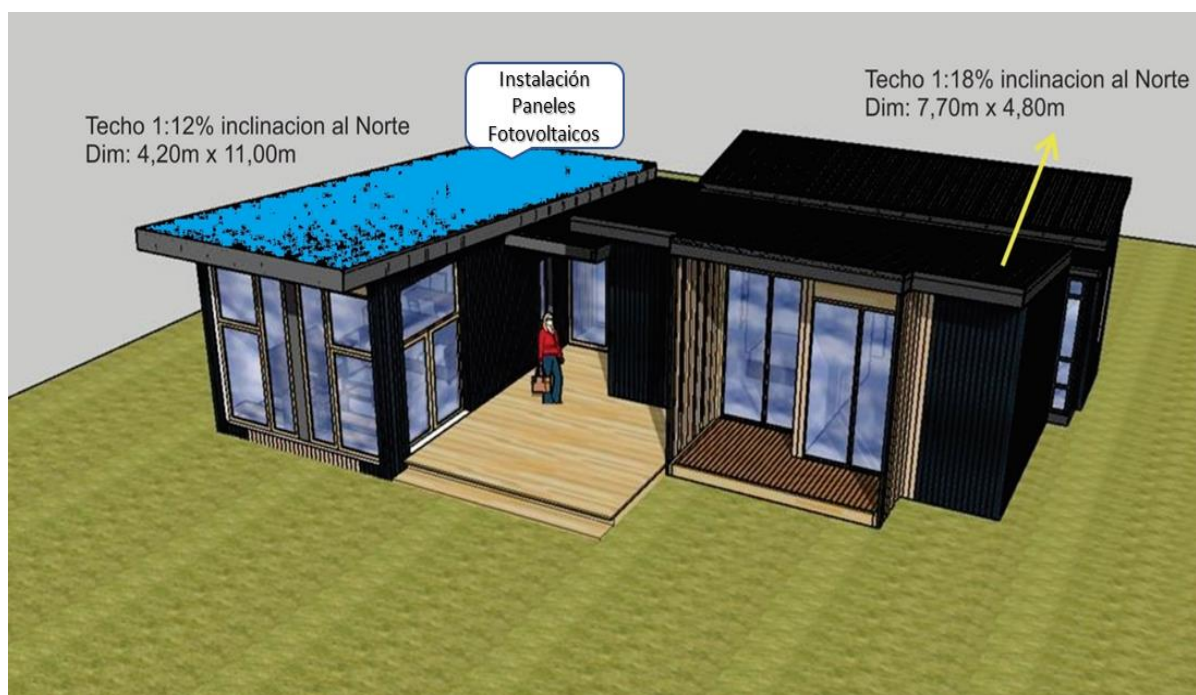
Proyecto Acantilados - Vivienda Tipo-Ubicación PFV
